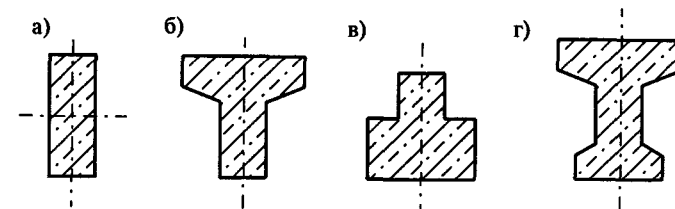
Сечения железобетонных балок: а) прямоугольное; б) тавровое; в) тавровое с полкой внизу; г) двутавровое
